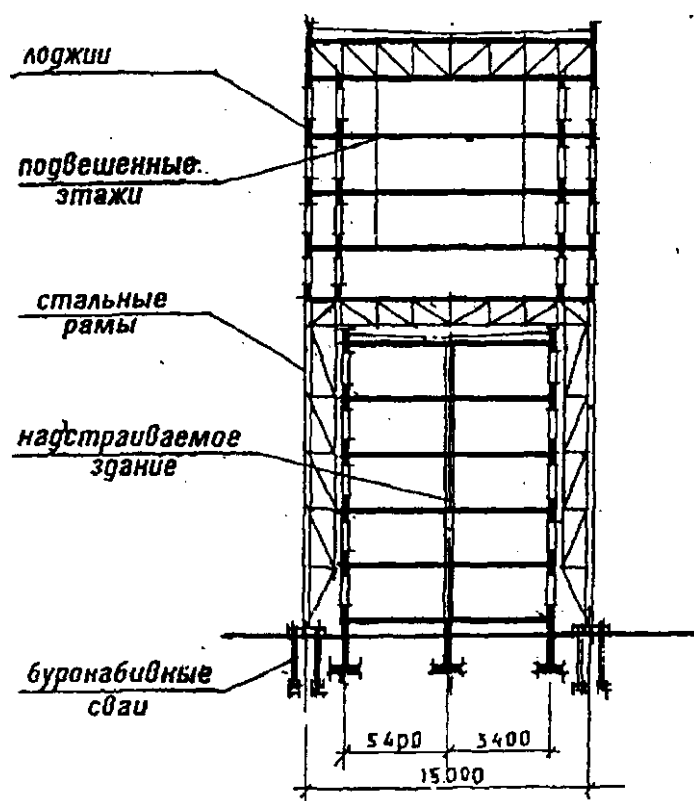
Надстройка здания до 12 этажей с опиранием на самостоятельные опоры. Метод «Фламинго»
